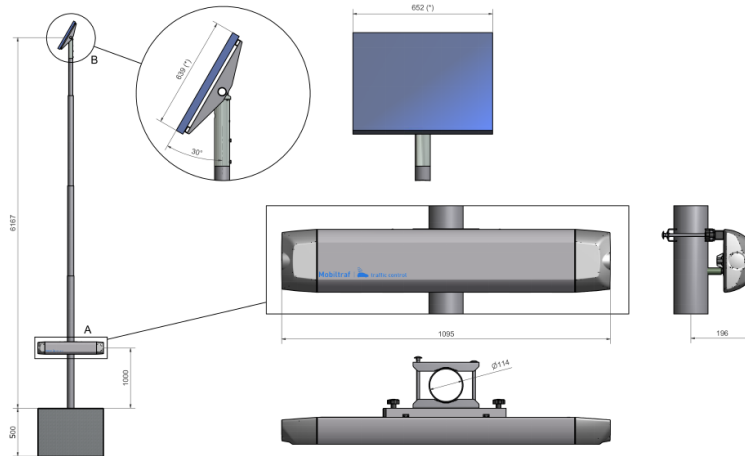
Plinto di fondazione e palo di supporto al rilevatore e al pannello
